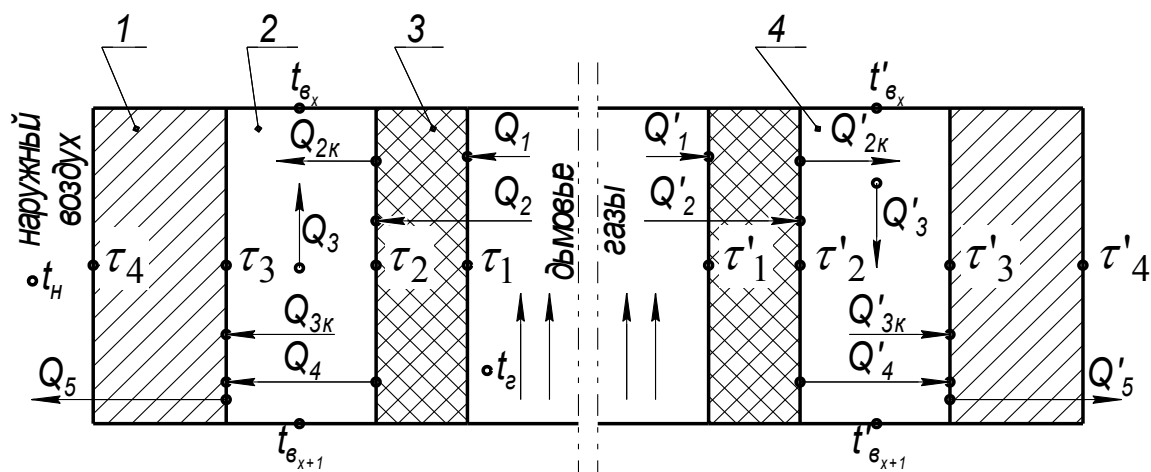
Схема теплообмена в дымовой трубе с воздушным каналом: 1 – железобетонный ствол; 2 – воздушный канал I; 3 – футеровка; 4 – воздушный канал II
